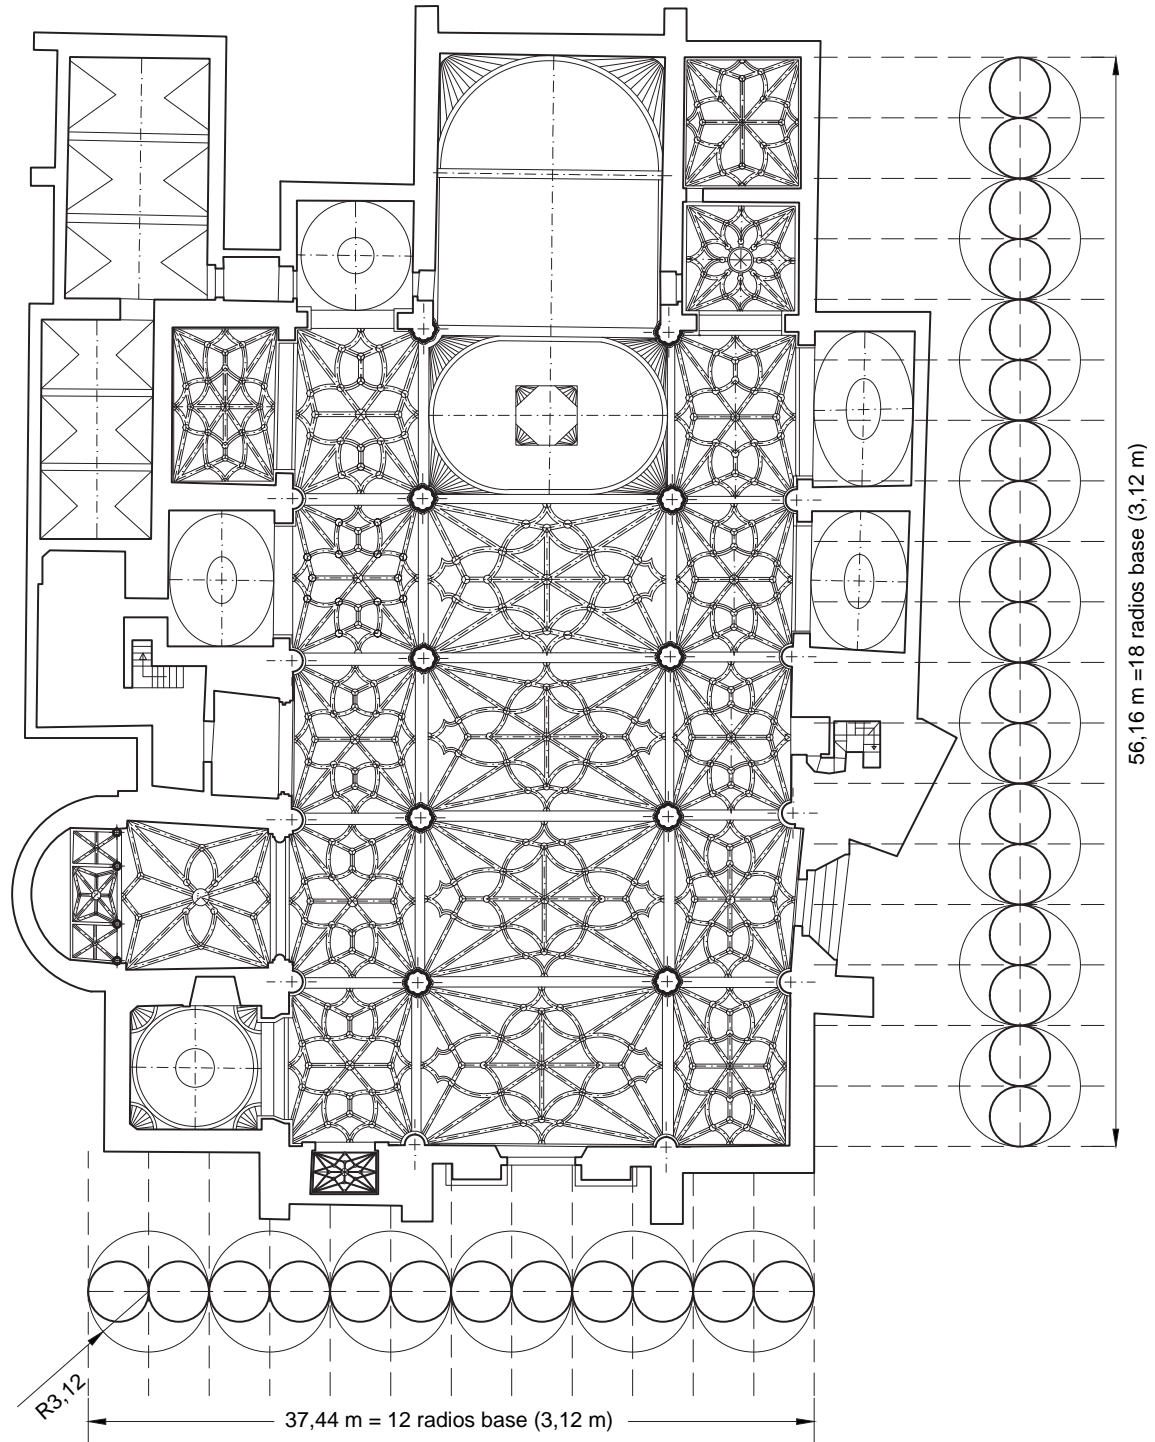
Proporción de la planta cenital de la Colegial de Santa María (Daroca)
